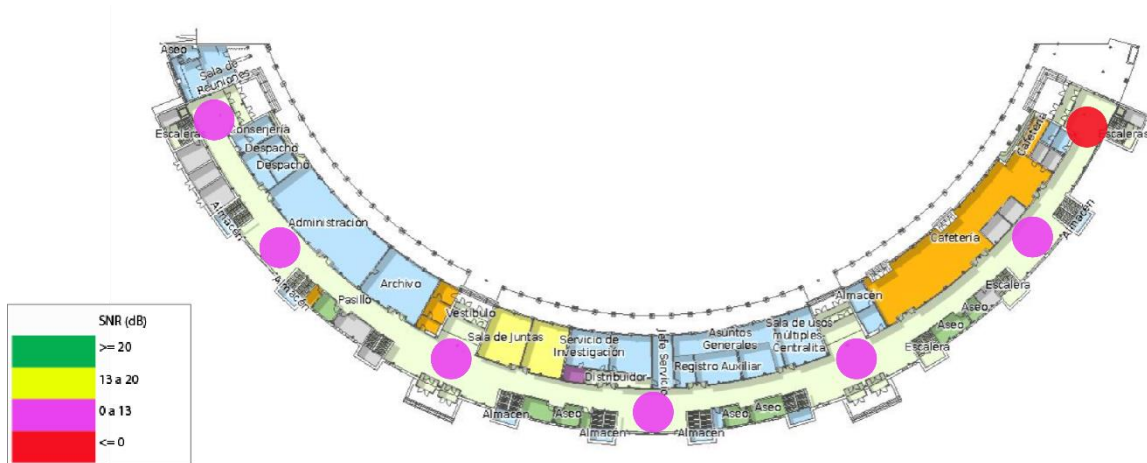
SNR Indoor - Aulario Sur, Planta 1
